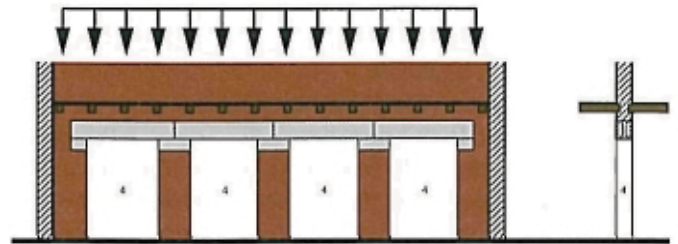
Abschnittsweise hergestellte Stahlbeton-Unterzüge in Bestandswänden
